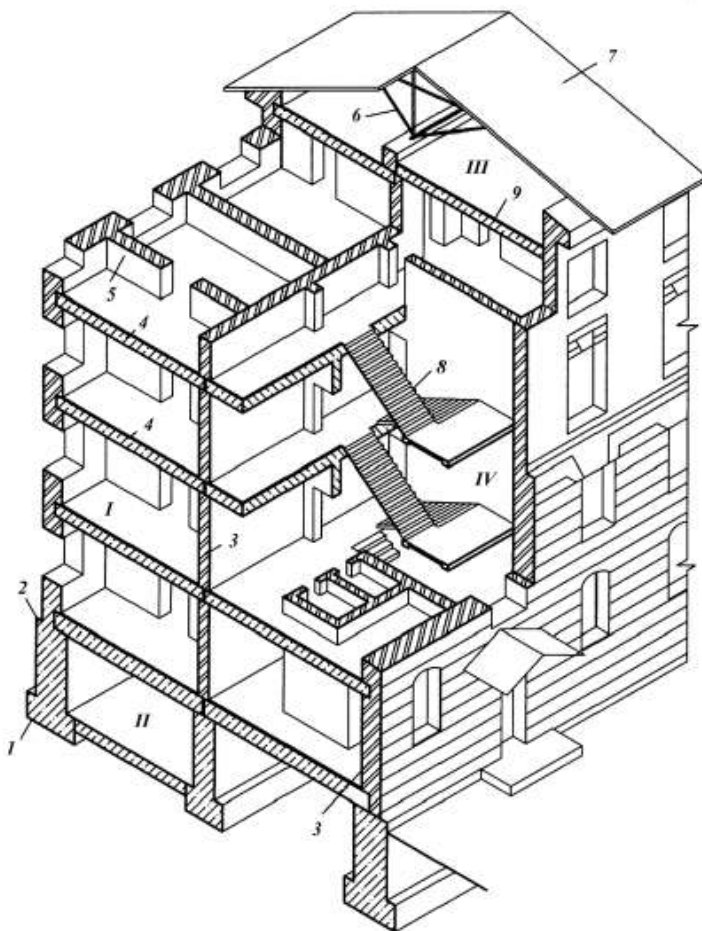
Об'ємно-планувальні та конструктивні елементи будівлі традиційної будівельної системи:
